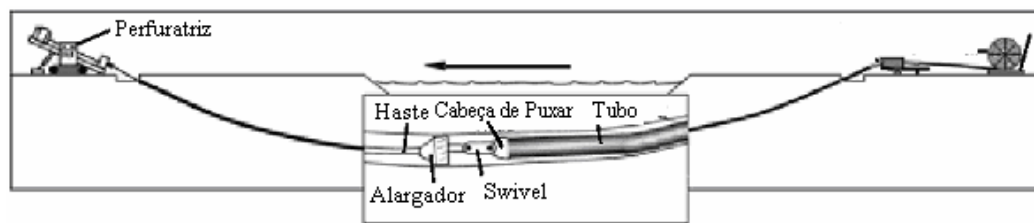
4 – Instalação da tubulação através do furo piloto (Technical..., 1999)
